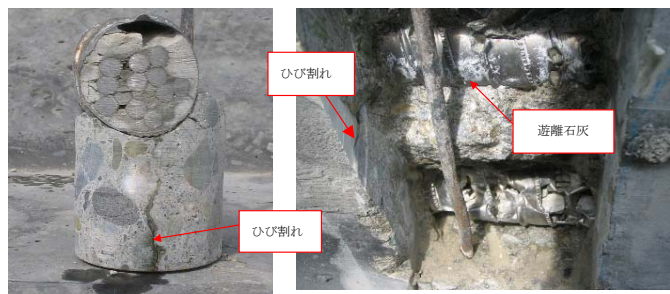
ひび割れ状況及びシース面に付着した遊離石灰
